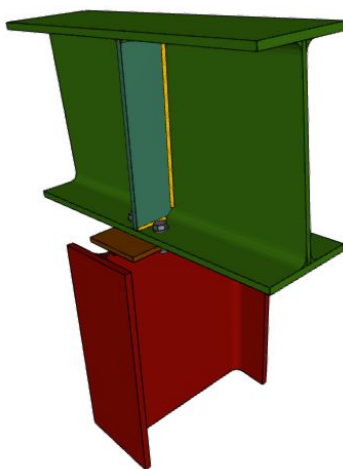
Unión articulada pilares intermedios-dintel pórtico fachada
